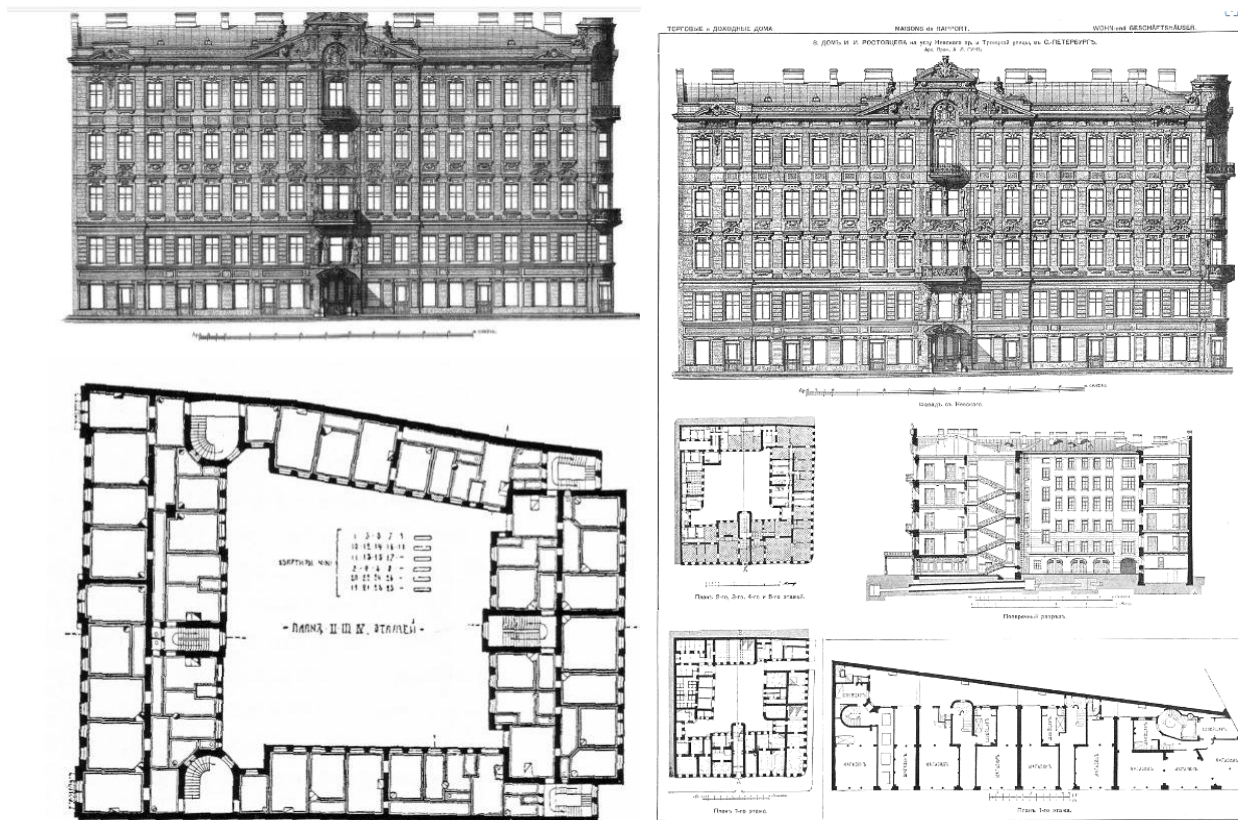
Слева - Доходный дом Г. А. Шульце в Петербурге, план, фасад, 1901-1902 К. Шмидт, ул. Куйбышева, 22 г.; справа – Доходный дом Ростовцева в Петербурге, проекции фасада, планов, разрезов.
